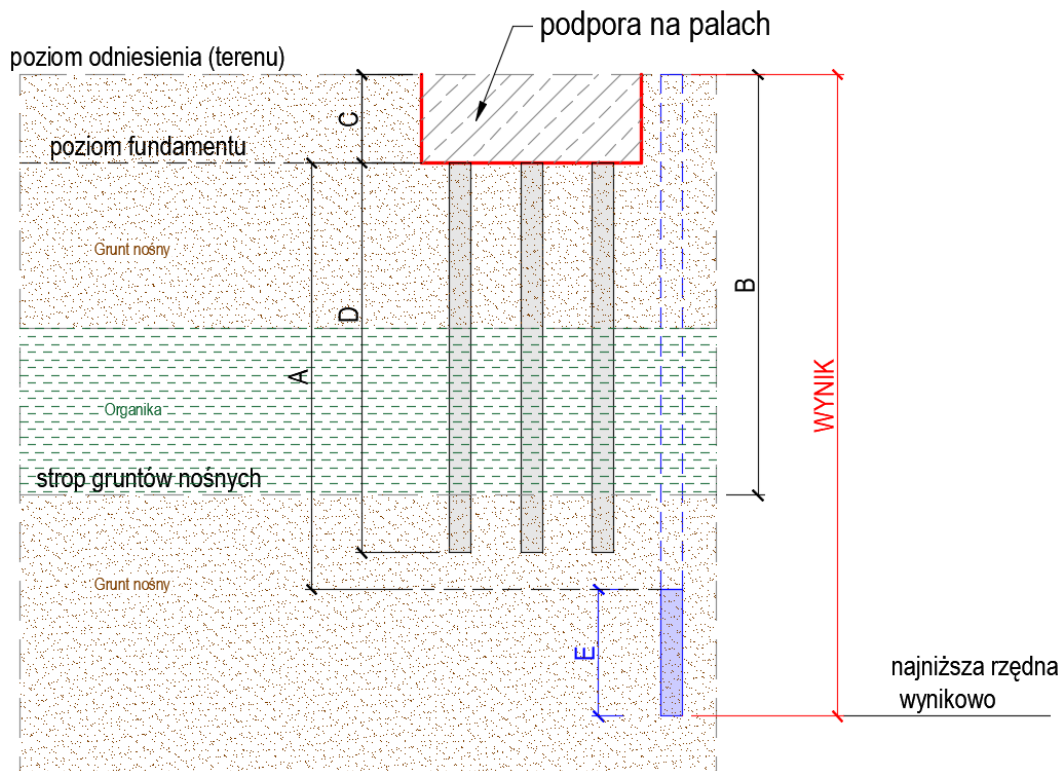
Schemat przyjmowania minimalnej głębokości otworu badawczego ze zwierciadłem gruntowym wg [3]
